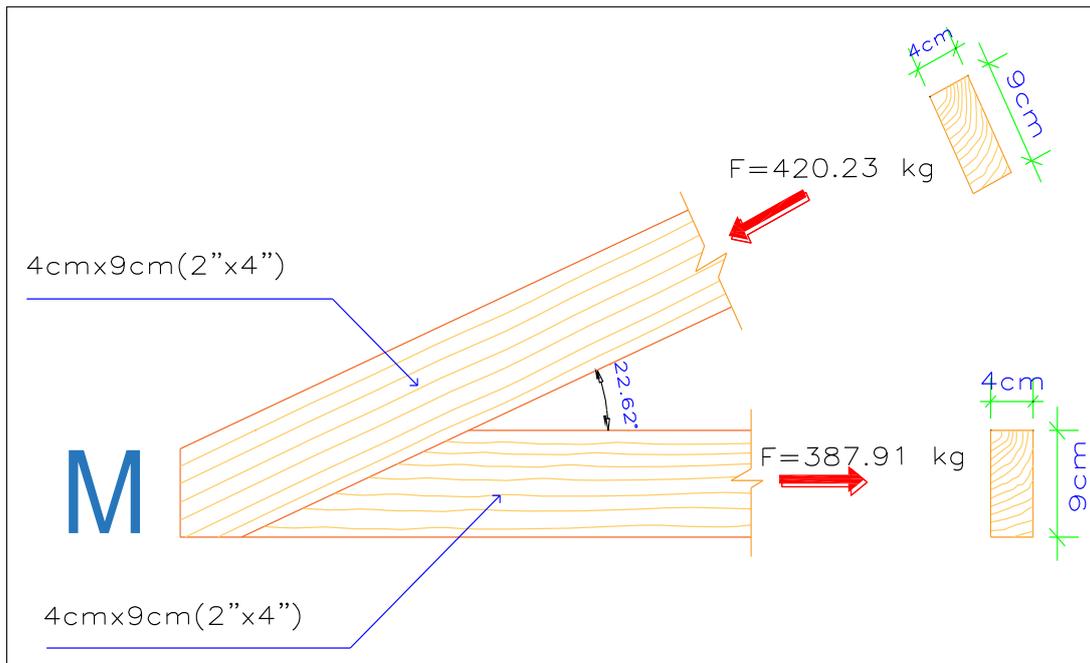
Nudo "M" de la armadura tipo montante maestro
